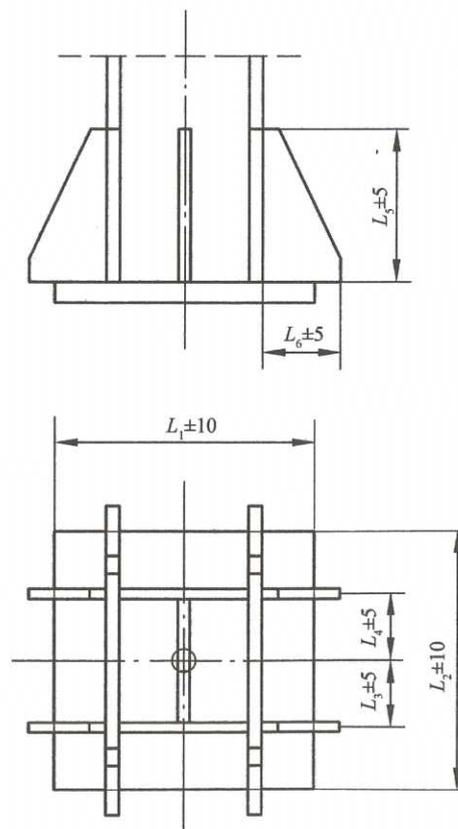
焊接柱脚的尺寸偏差 (类型 II)
